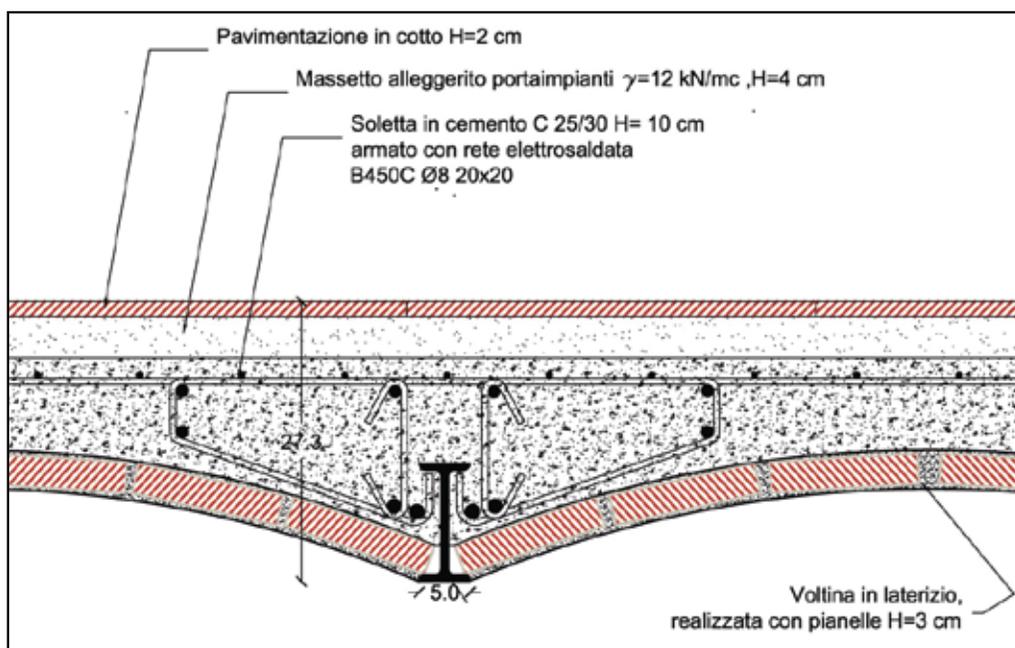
Rinforzo con soletta collaborante in calcestruzzo armato
